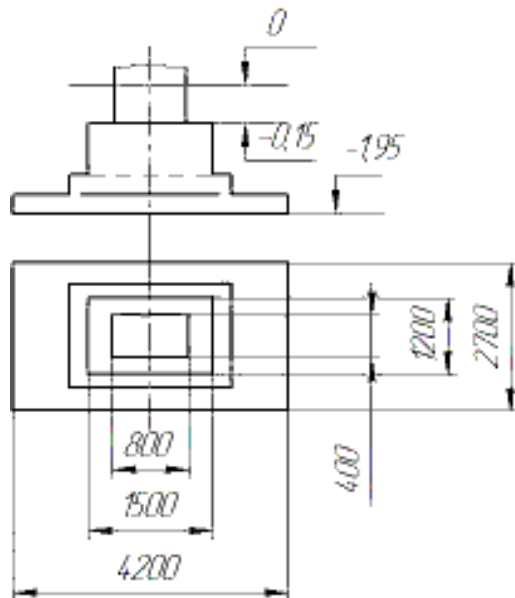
Фундамент под колонны серии КЭ-01-49
